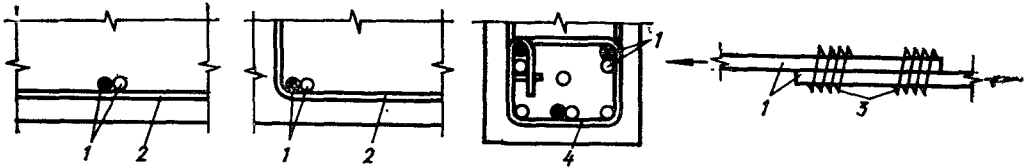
Установка дополнительной поперечной арматуры в зоне стыкования растянутых стержней внахлестку без сварки:
